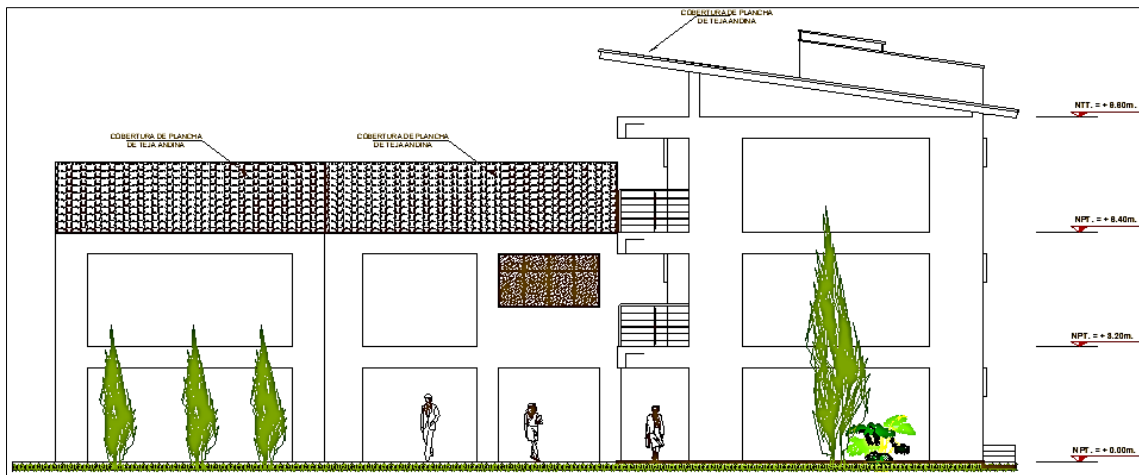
Vista lateral 2 del Pabellón de Turismo y Hotelería (Fuente: Planos de elevación)
